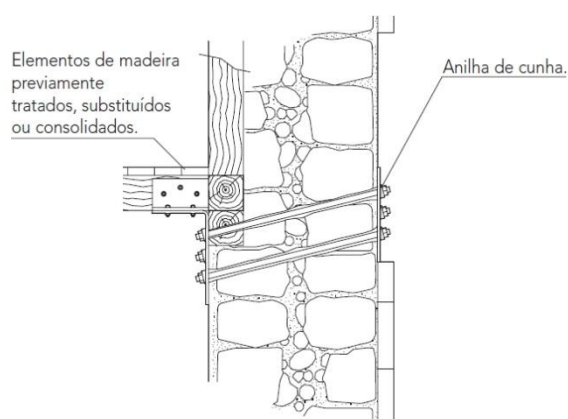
Fixação de um perfil metálico à parede (Cóias [6])
